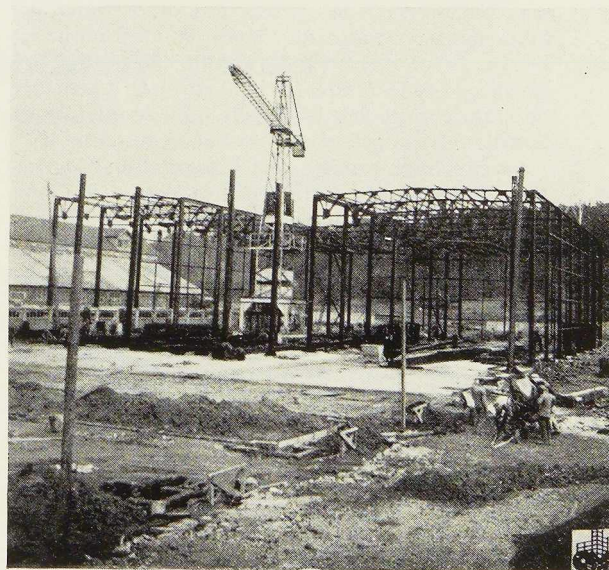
La nouvelle charpente en construction (photo prise 9 jours après le commencement des travaux).
